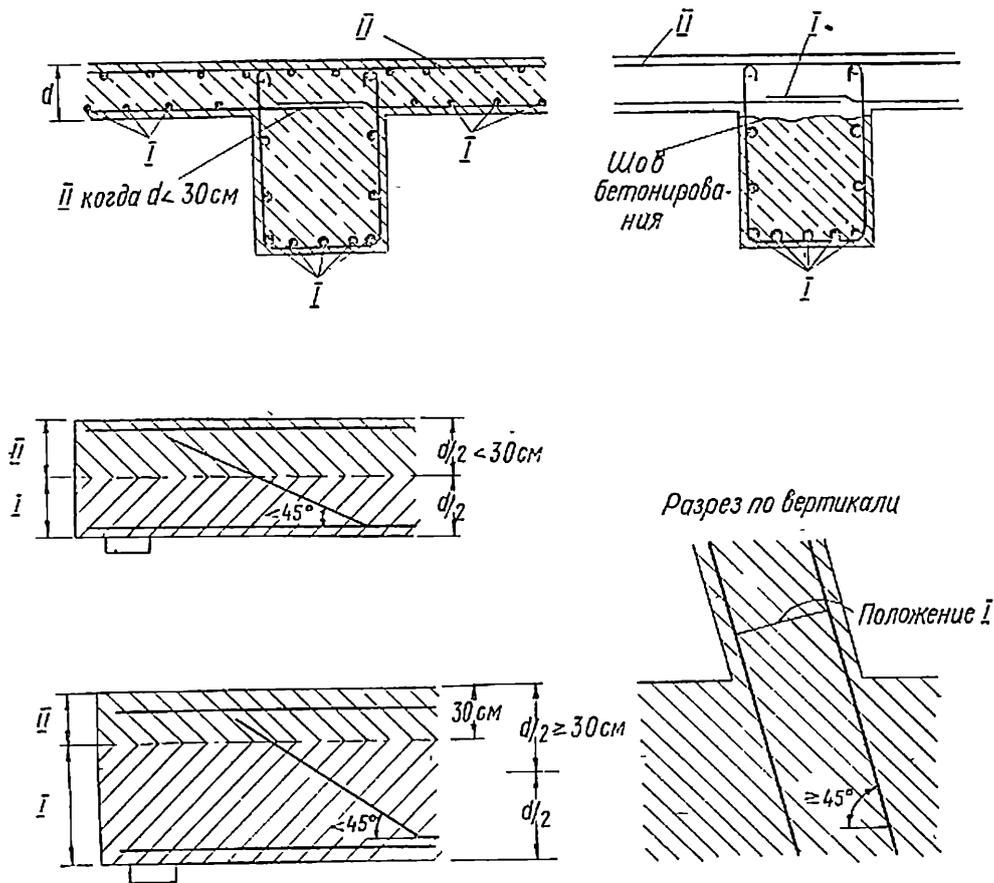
9. Положение арматурных стержней в хорошем (I) или ухудшенном (II) условиях сцепления
